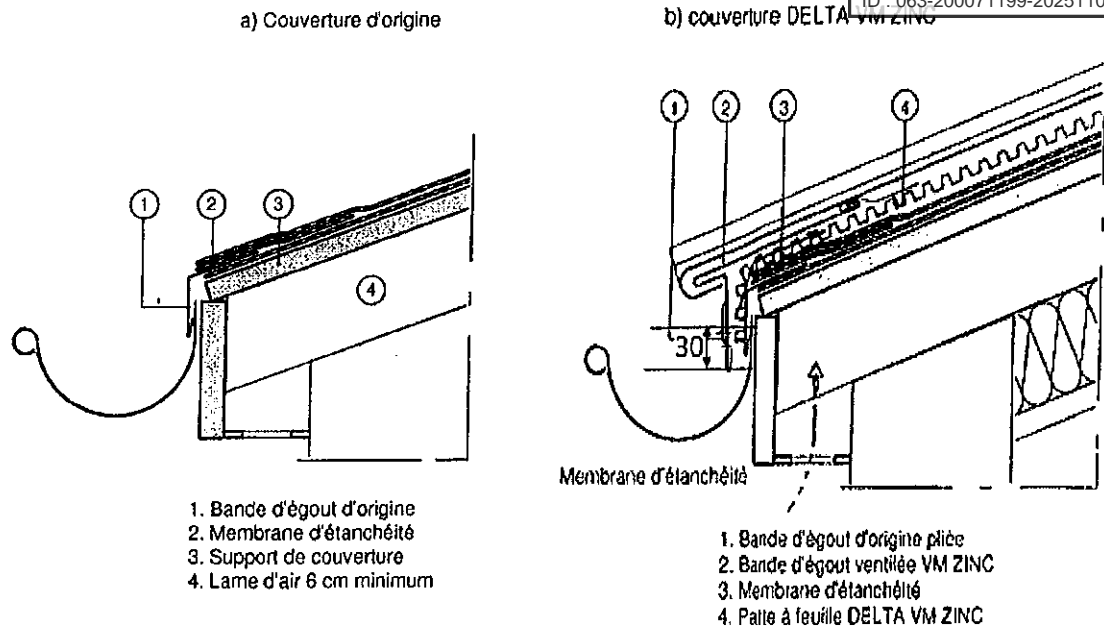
Egout, couverture en réfection sur membrane d'étanchéité
